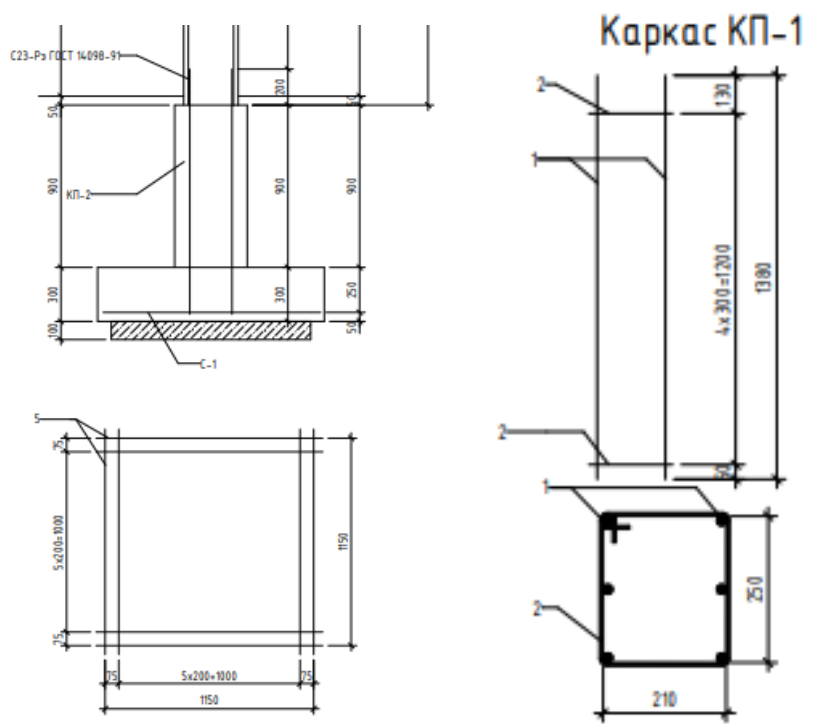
Армуння фундаменту, каркас просторовий КП-1
